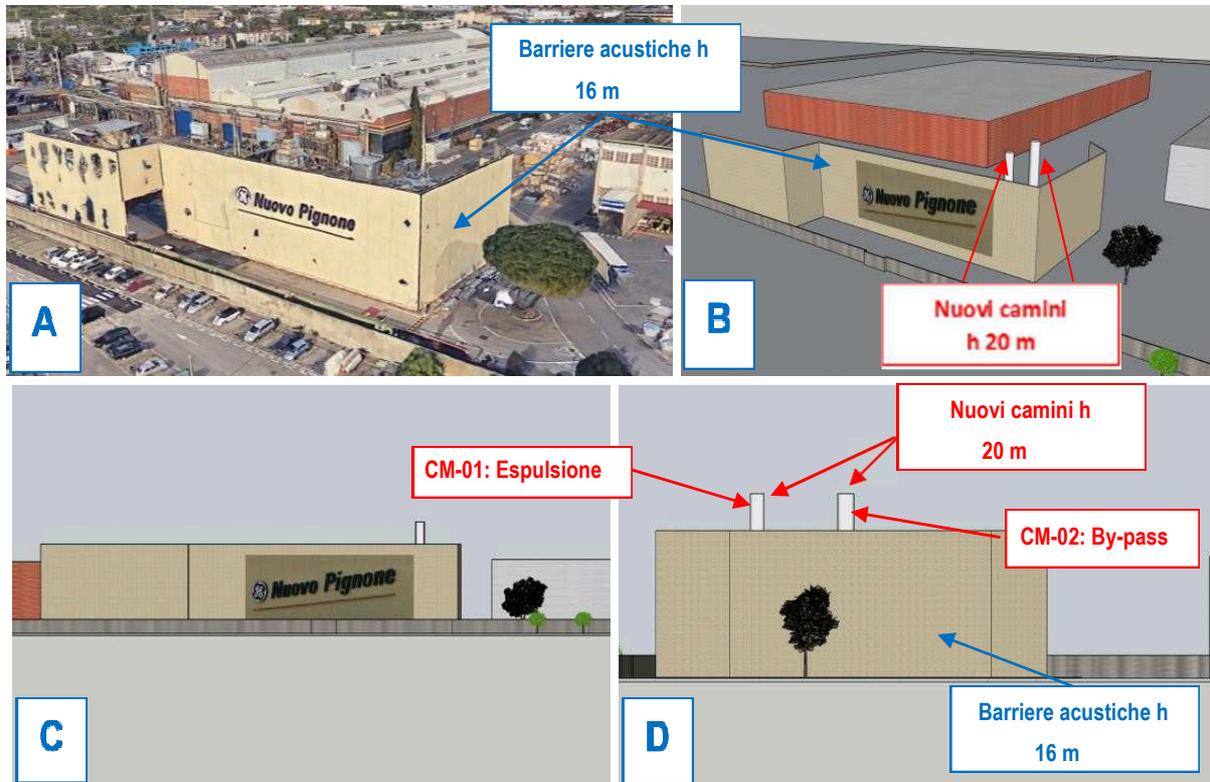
A) Vista aerea situazione attuale; B) Sketch vista aerea situazione futura; C) Proiezione frontale (esterna); D) Proiezione laterale (interna)
